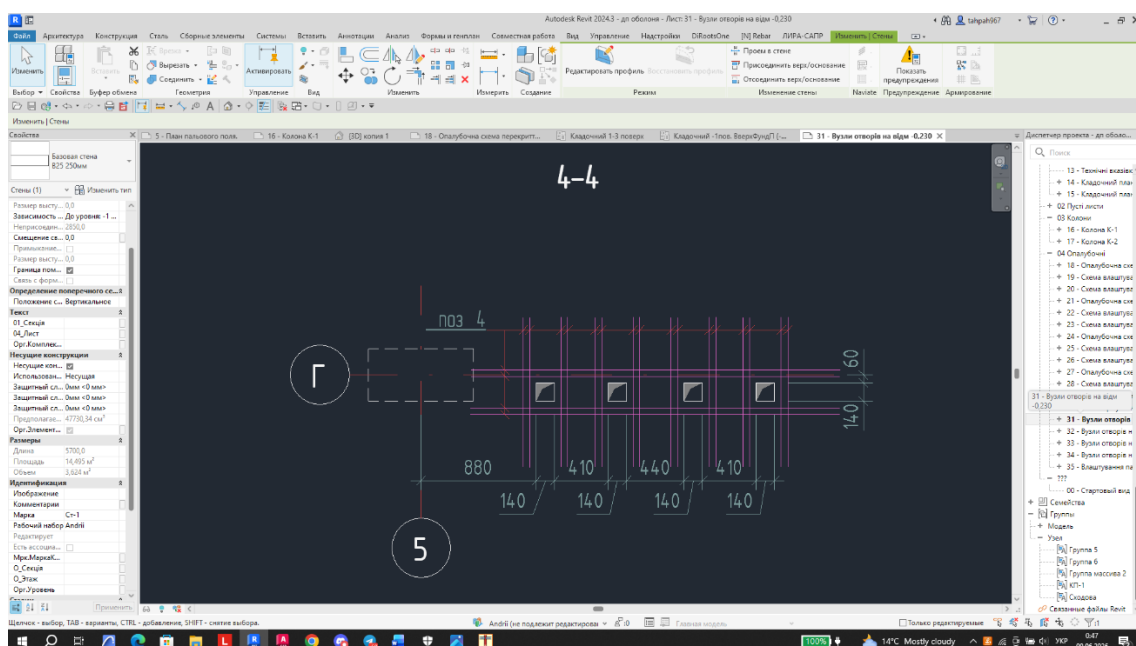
Армування вузла плити перекриття на рівні -0.230
